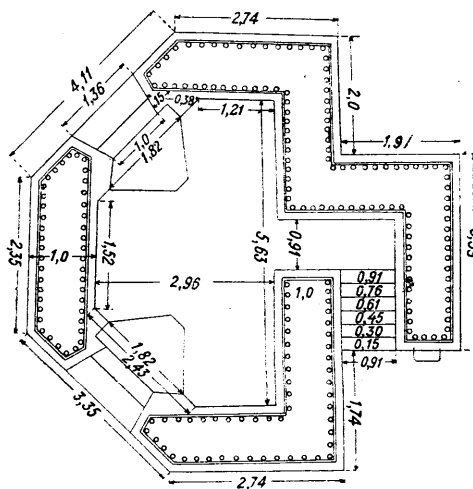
Железобетонные казематы для пулеметов (план на высоте амбразуры).
